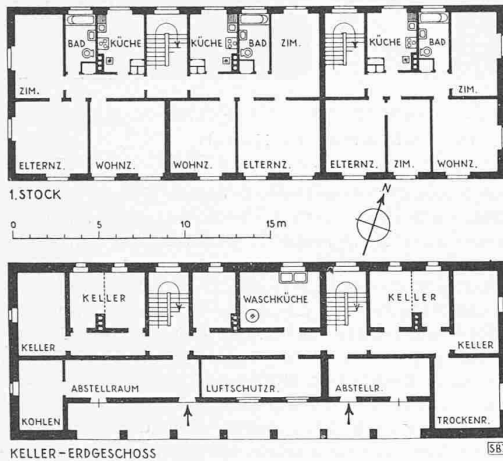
Grundrisse Block 3, Masstab 1:400
